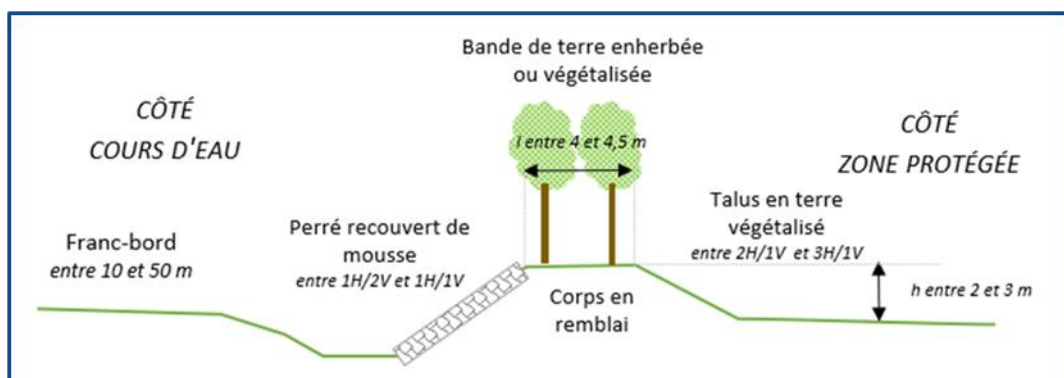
Coupe type du système d'endiguement de Lamothe – Tronçon 1 / Section b (T1b)
